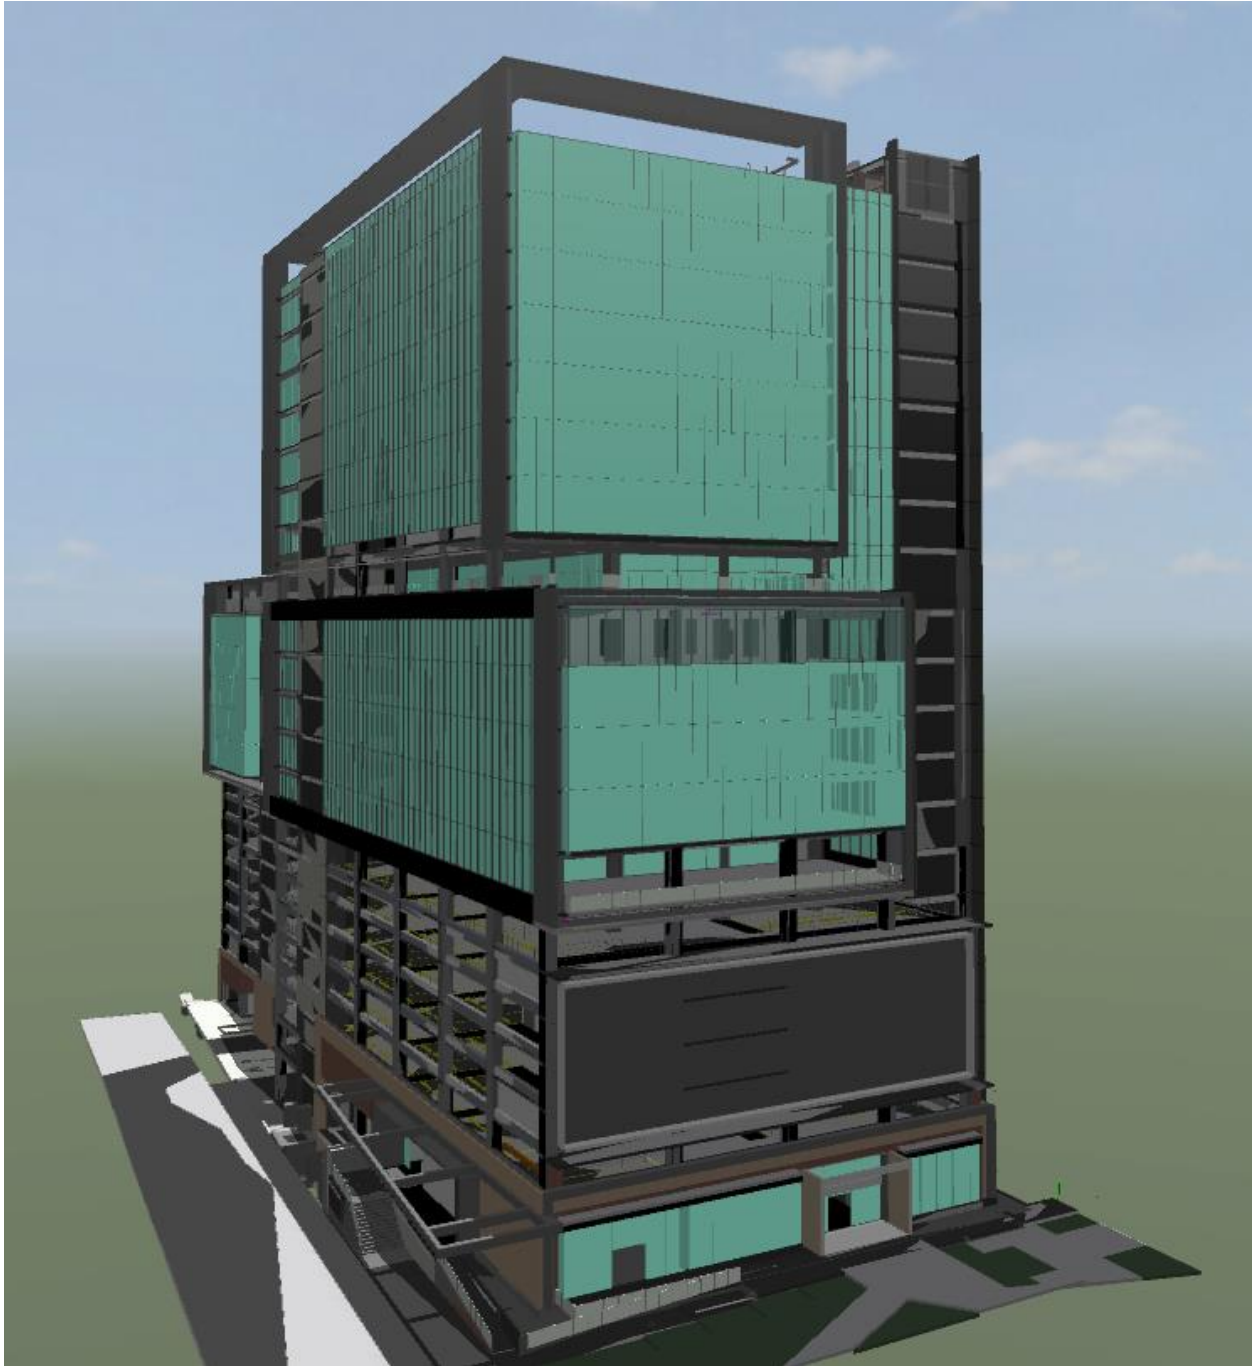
Fachada noreste. Fuente: Extralum (2019)
